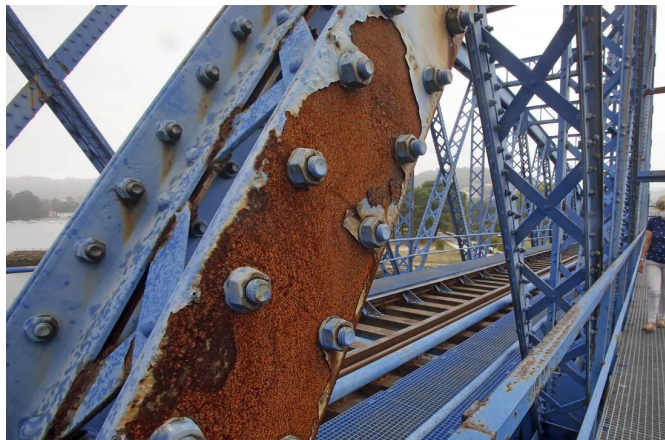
Detalle de la oxidación en un puente metálico (www.lavozdegalicia.es)
